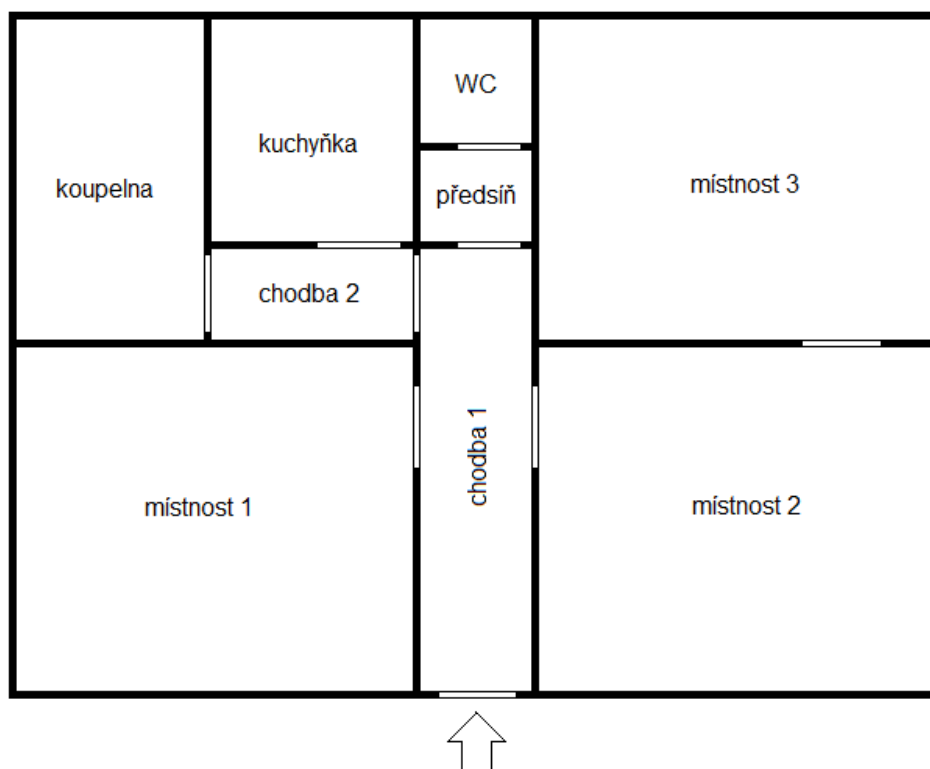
SO 03-55-01, domek TO; půdorysné schéma domku s označením místností
